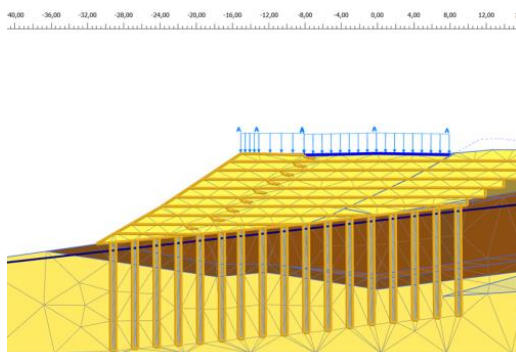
Модель расчетной осадки армонасыпи и грунтового основания с щебеночными сваями в виде сети КЭ.
